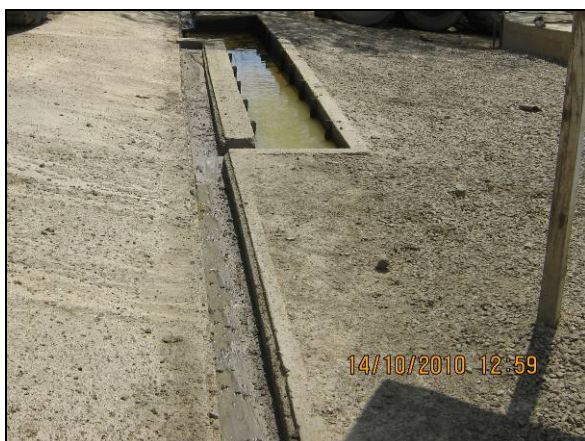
Canaleta de direcionamento de efluentes e caixa de areia do lavajato (out/10).
